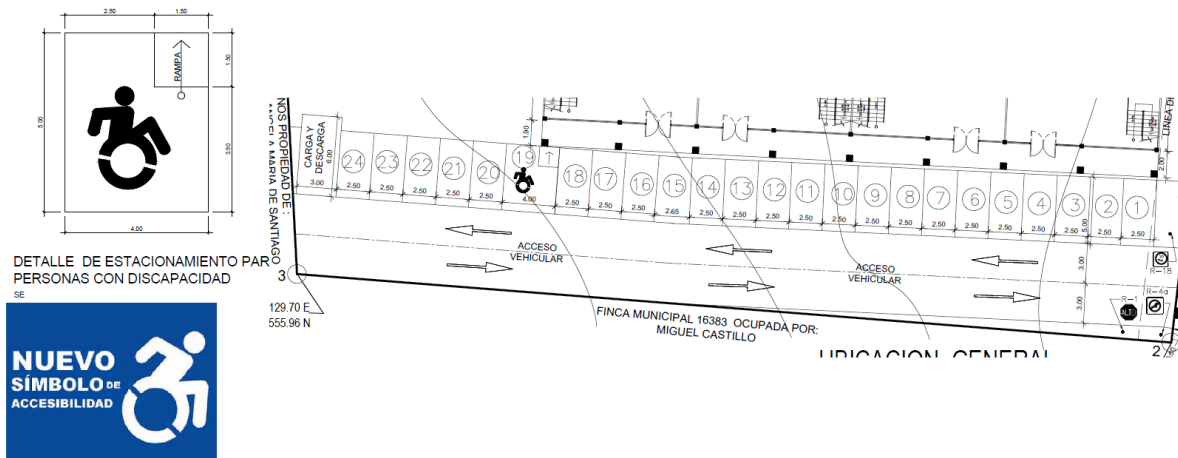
Detalle de estacionamiento para personas con discapacidad e imagen de los 24 estacionamientos a realizarse con el área de carga y descarga. Fuente: Planos del proyecto, 2024.
